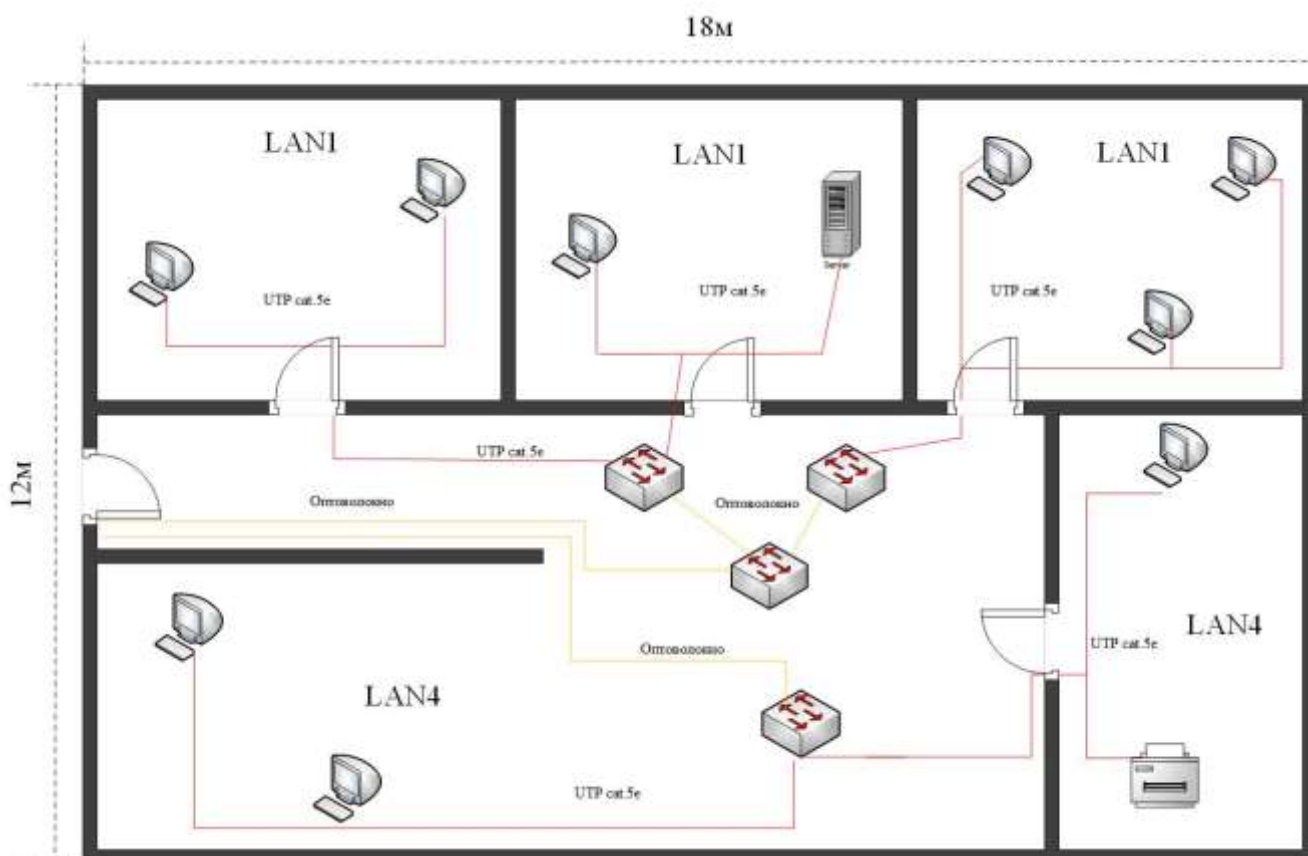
Схема проводки кабелів та розташування обладнання в одній будівлі
